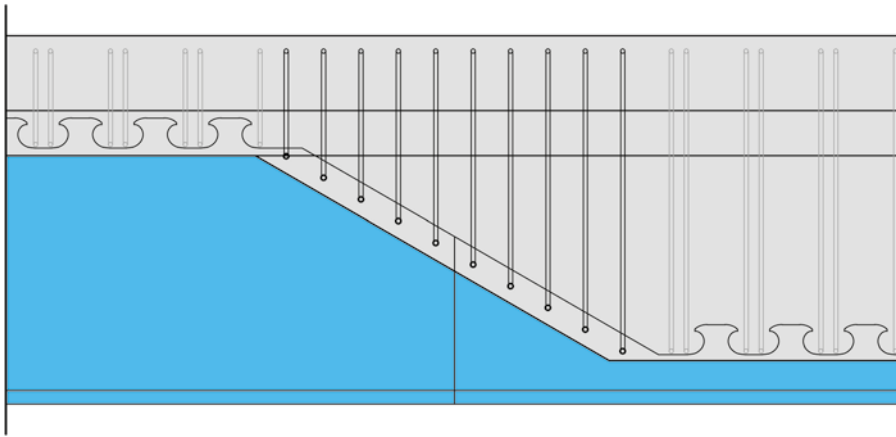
Übergangsbereich zwischen Stahlsteg und Betonsteg des Trägers
